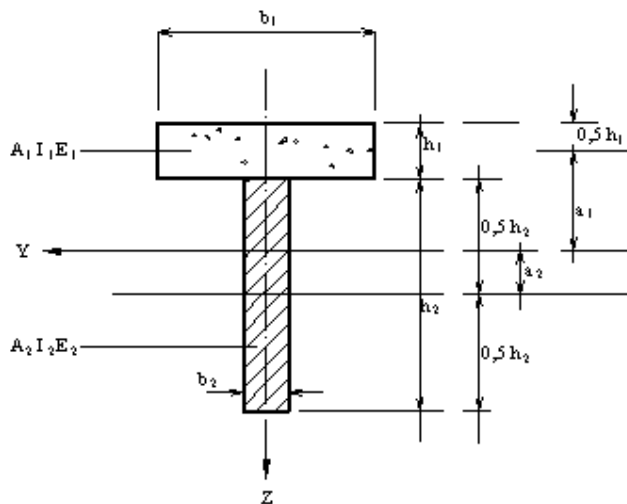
Seção transversal de viga mista madeira/concreto.
